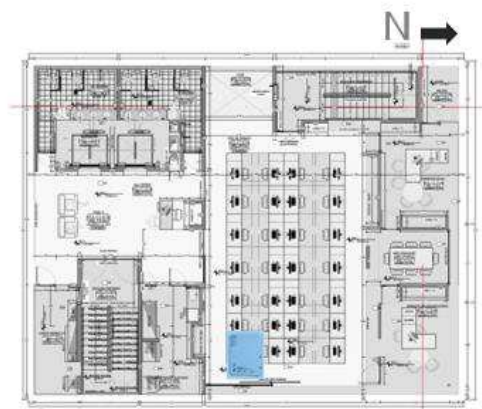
Planta del octavo piso. Se resalta la ubicación del anemómetro sobre la fachada oriental.
